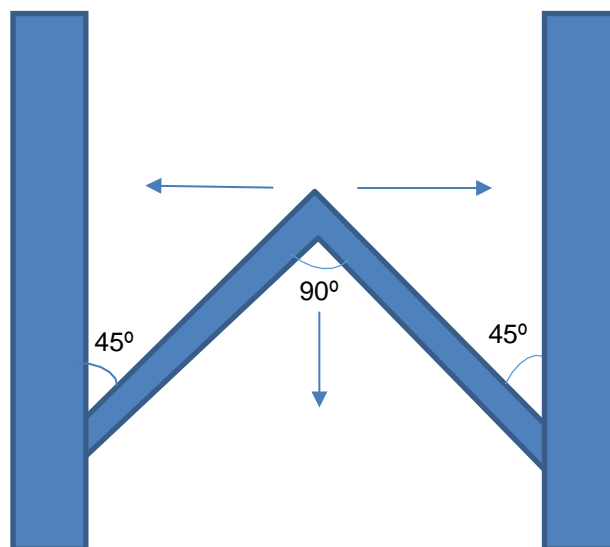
Vista esquemática em planta do assentamento em espinha.
